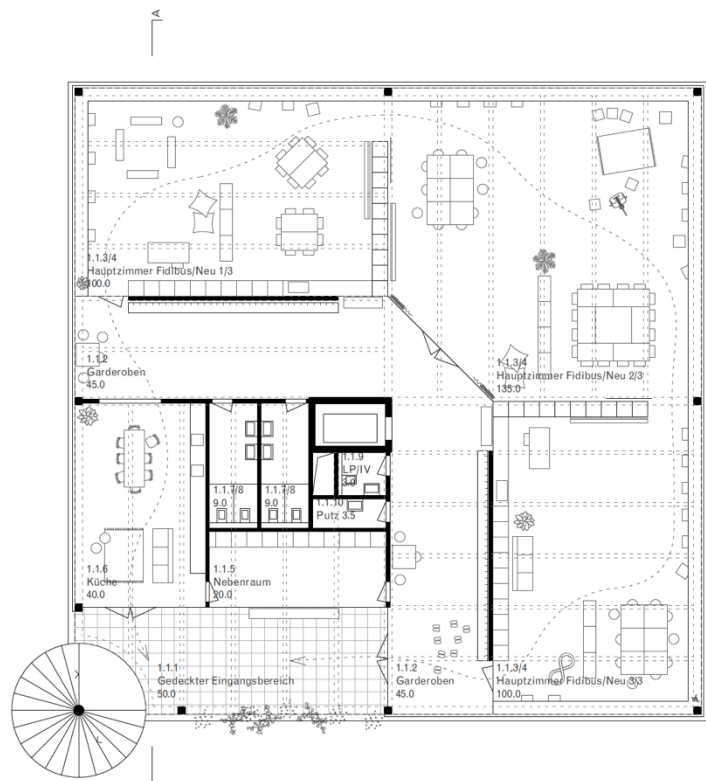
Grundriss Zyklus 1, 1. Und 2. Obergeschoss
